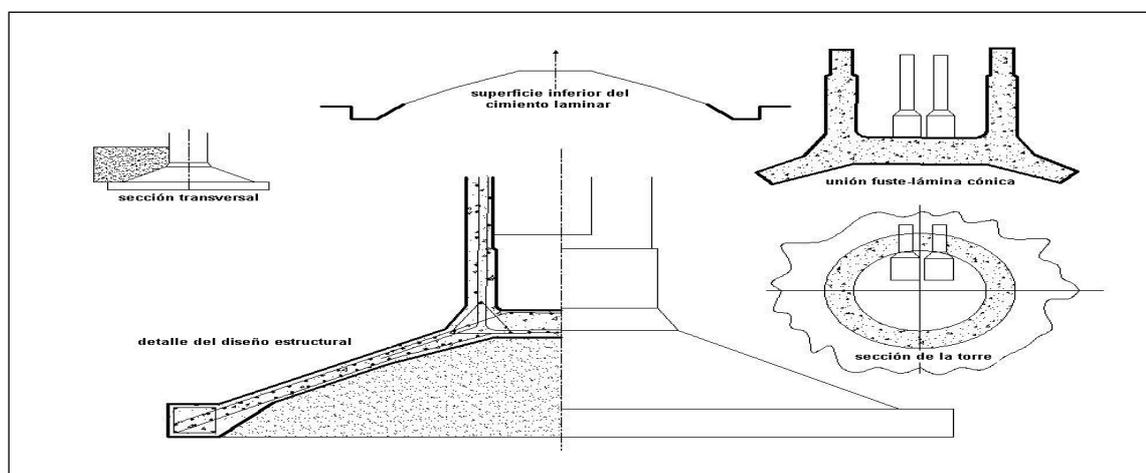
Detalles del cemento aplicado en la construcción del depósito elevado tipo güira del Instituto de Ciencia Animal, en Catalina de Güines. [8,29]
